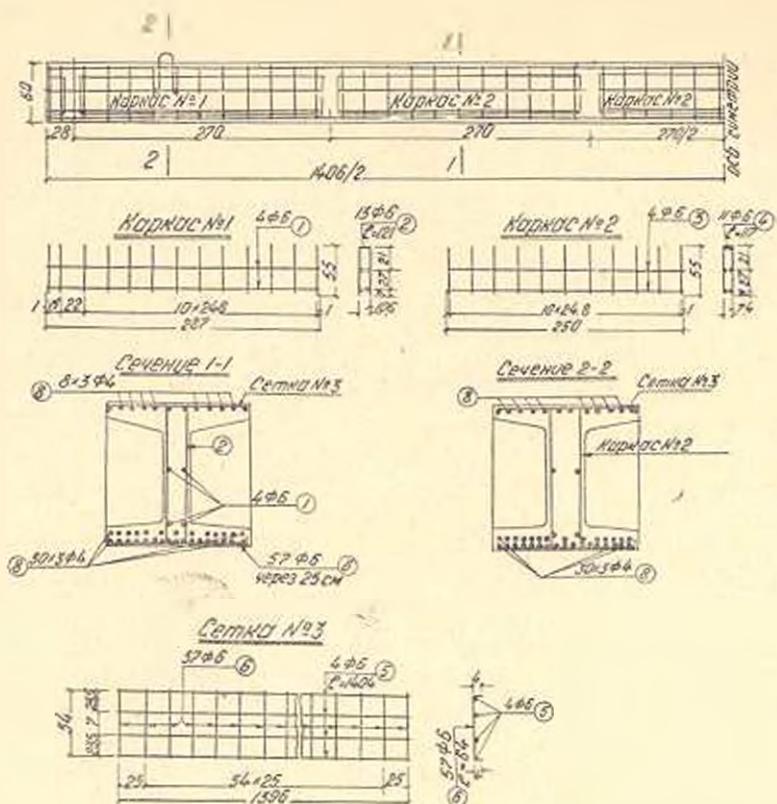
Конструкция опытной струнбестоной балки длиной 14,06 м.
